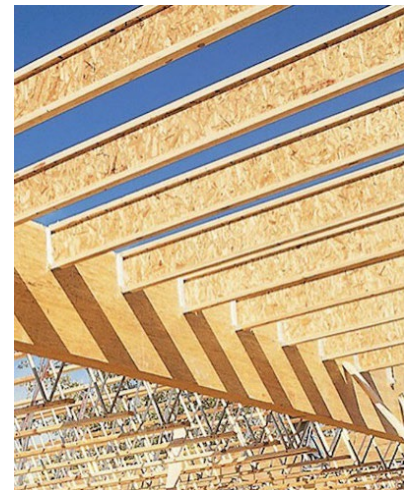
Viga de madera (Fuente: Maderas Casais)
